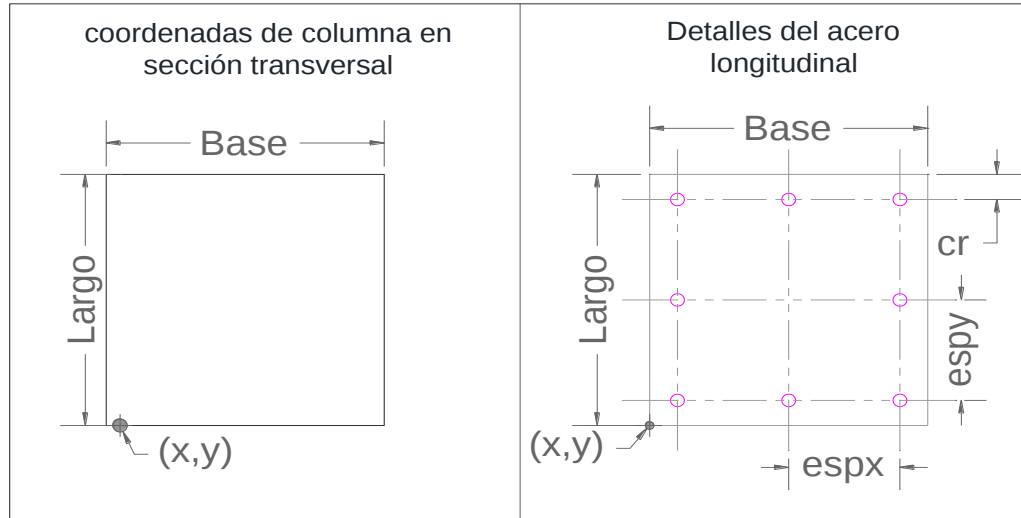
Detalle de bordes y acero longitudinal en vista de corte
